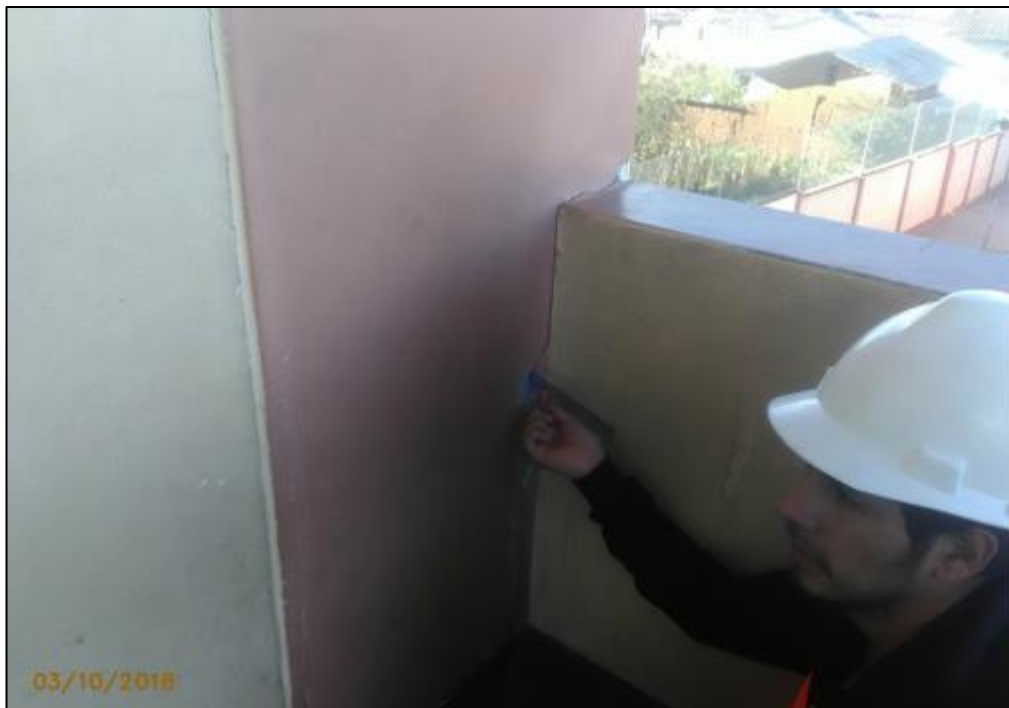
Módulo 01: 1°, 2° y 3° piso, presencia de una grieta en la unión del muro del voladizo en el eje 10-10 tramo voladizo.
